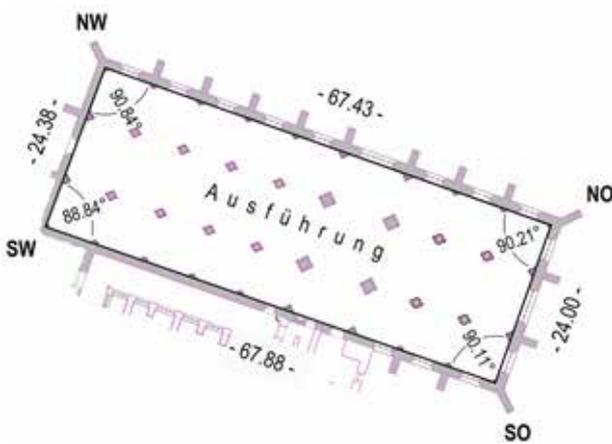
Münster Neuberg, das Grundrechteck (inneres Rechteck) der Planung wird durch die Ausführung zu einem beliebigen Viereck, dessen Geometrie aus Plan Abb. 6 (oben) mittels CAD im metrischen System graphisch erfasst wurden.
